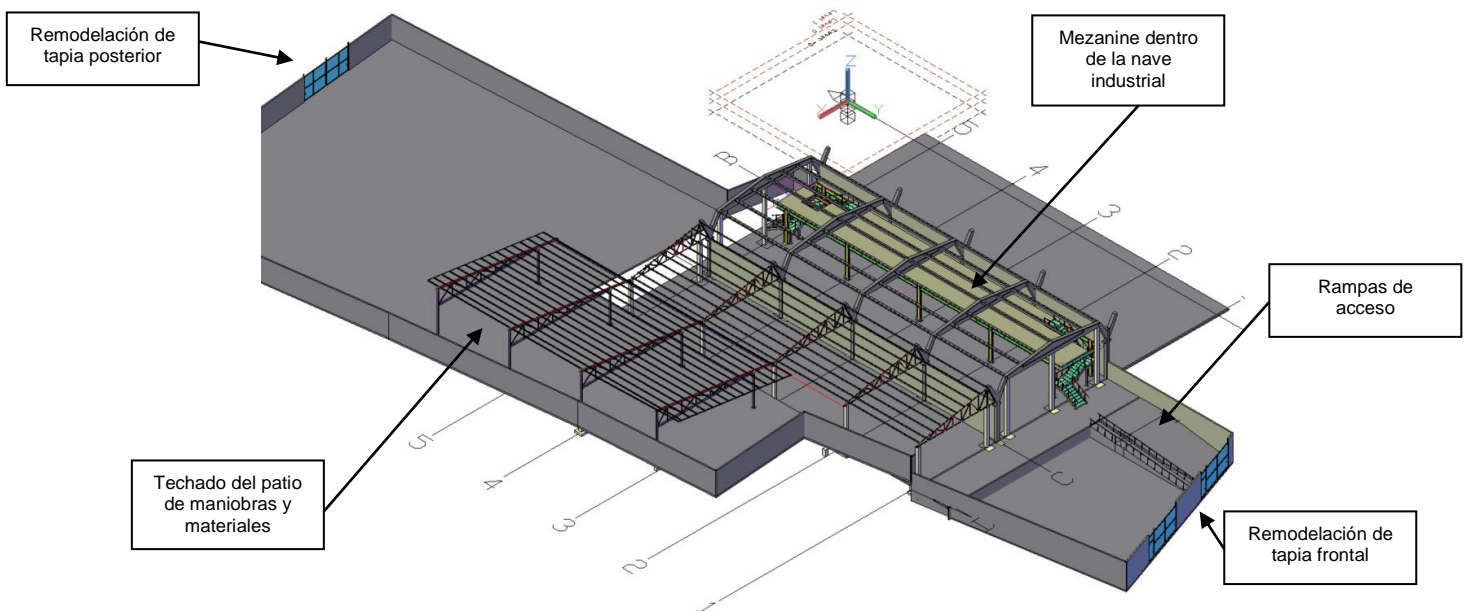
Modelo de las nuevas obras por desarrollar en la planta
